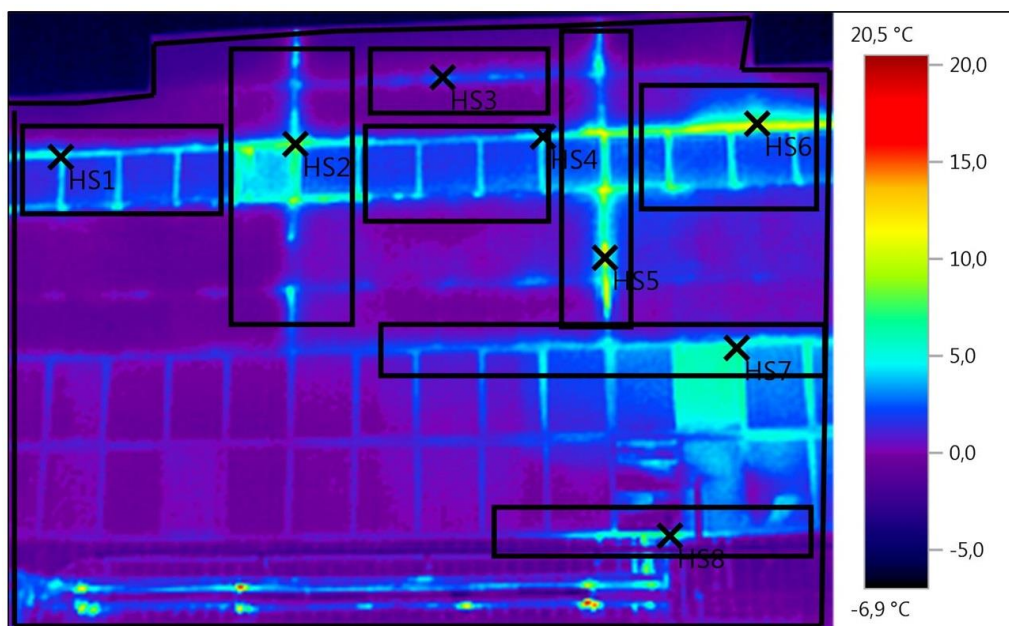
Тепловизионное обследование стены, выявившее дефекты теплоизоляции.
